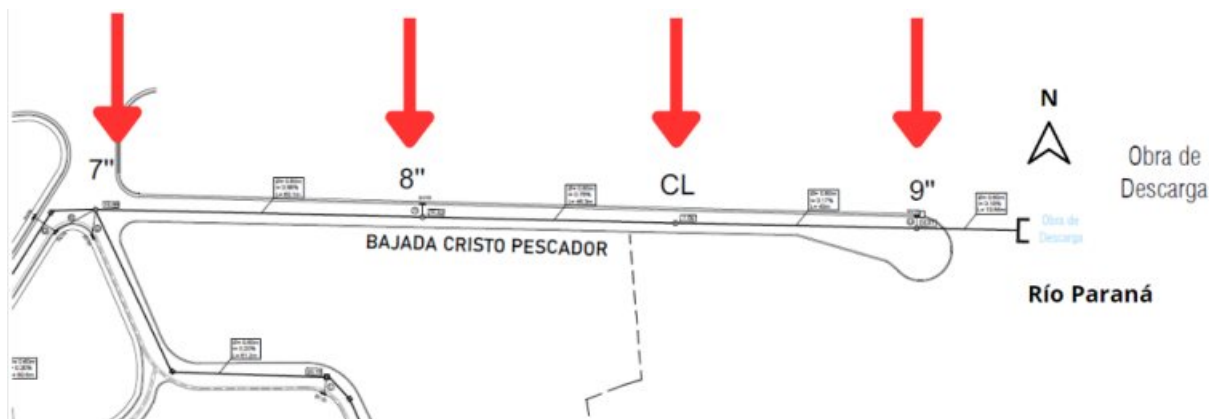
Planteo definitivo ubicación de cámaras de caída; esquema en planta.
